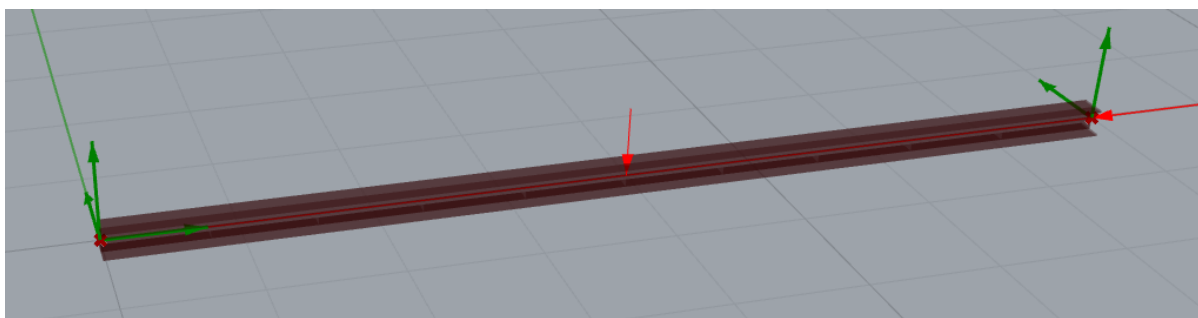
Primer Caso de Estudio, Viga Simplemente Apoyada
